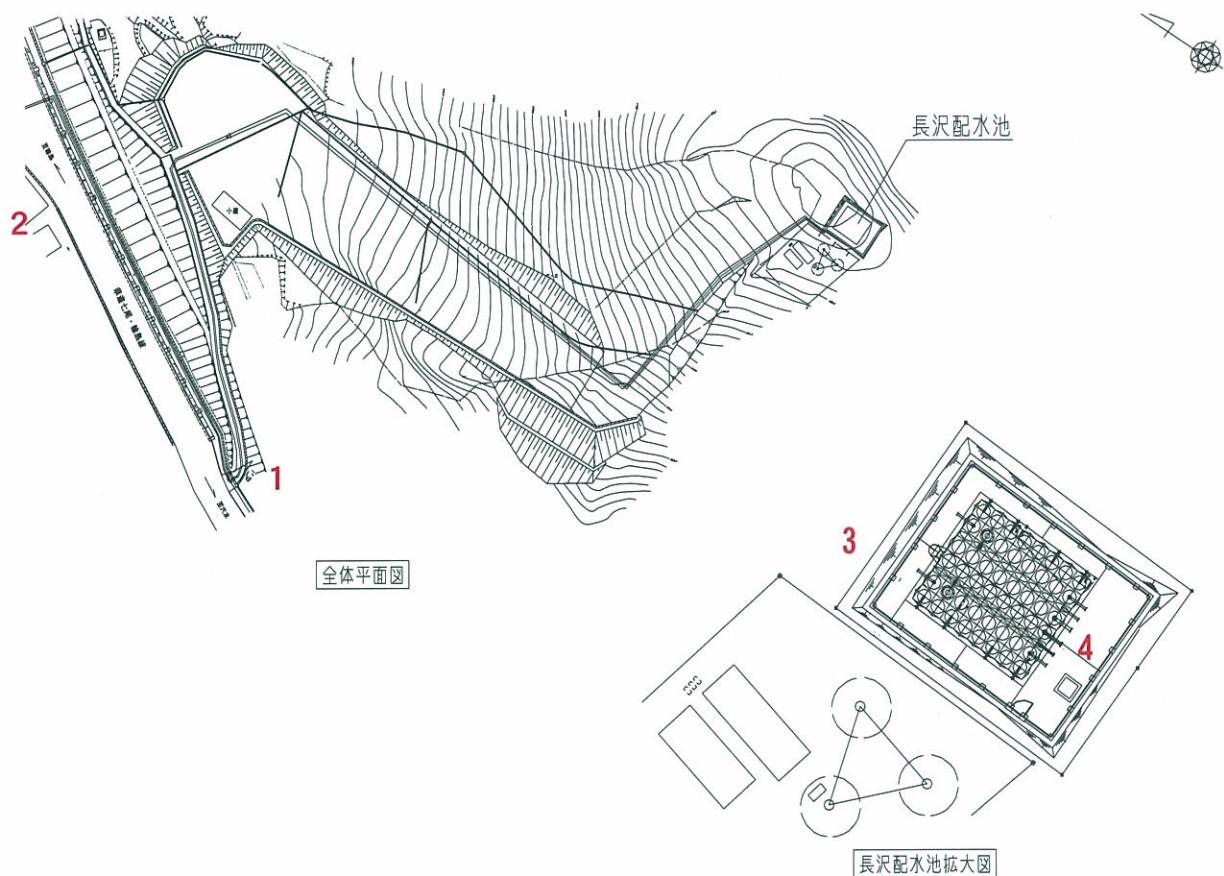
配水池全体平面図、周辺状況写真位置図（写真 5.7 参照）
